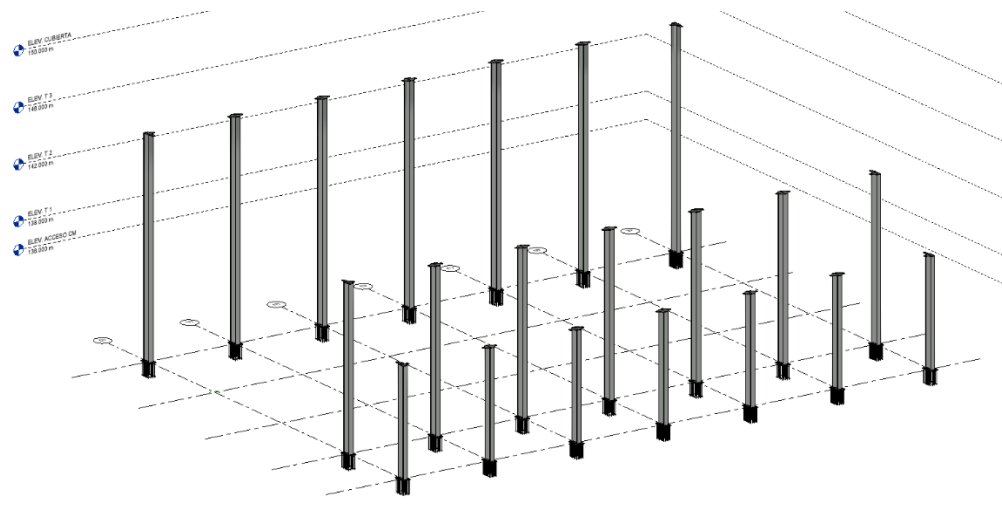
Columnas principales W 610X241 (elaboración propia).
